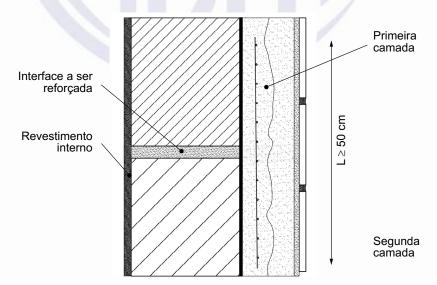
Posicionamento da tela para atenuação de fissuras
